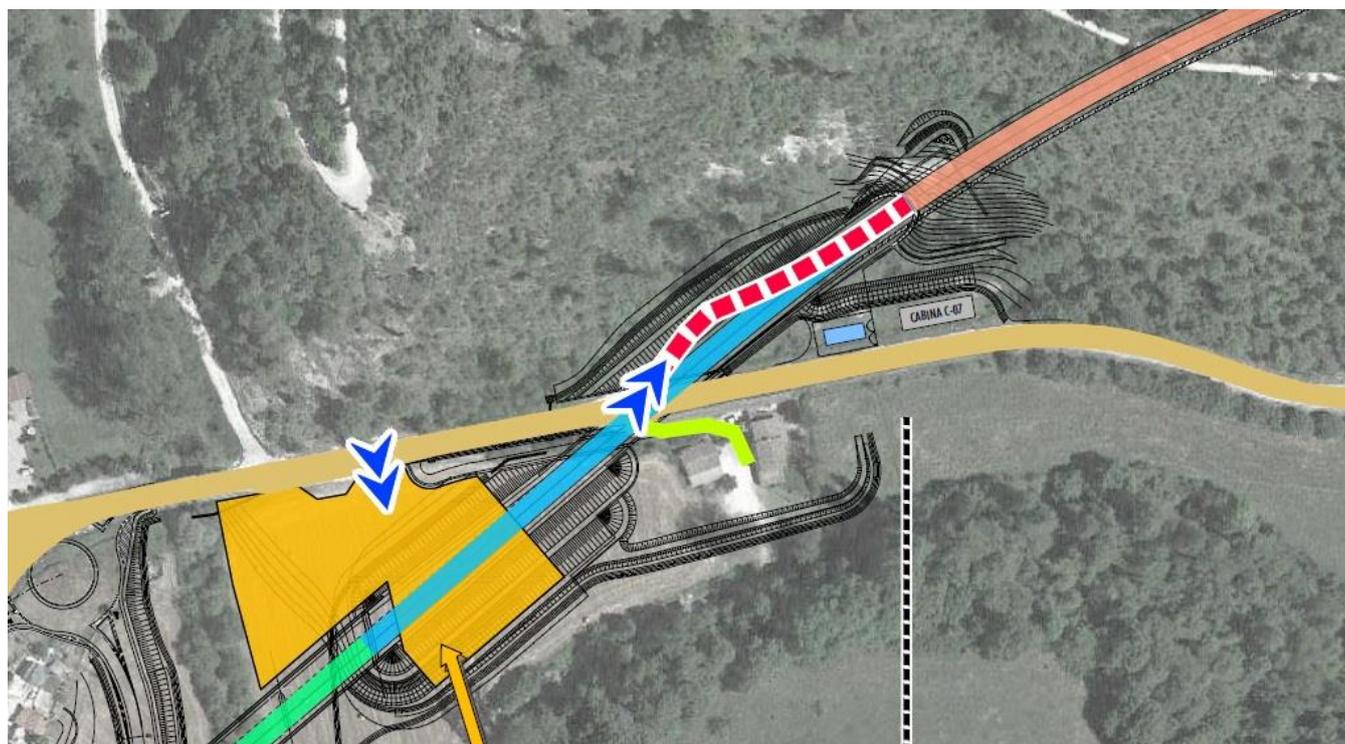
PISTA DI CANTIERE PER IL COLLEGAMENTO DELL'AREA DI LAVORO PRESSO L'IMBOCCO OVEST DELLA GALLERIA PIETRALUNGA 1 (ESTRATTO DALL'ELABORATO T00CA01CANPL01A)
